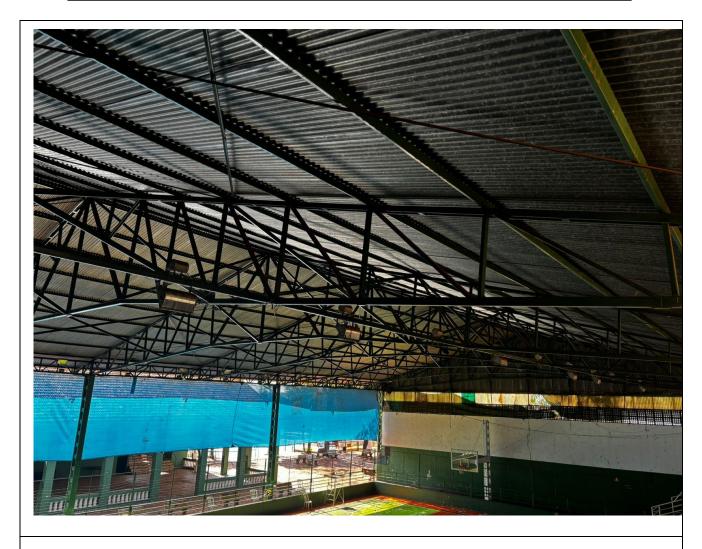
Vista parcial da estrutura da cobertura da quadra.
